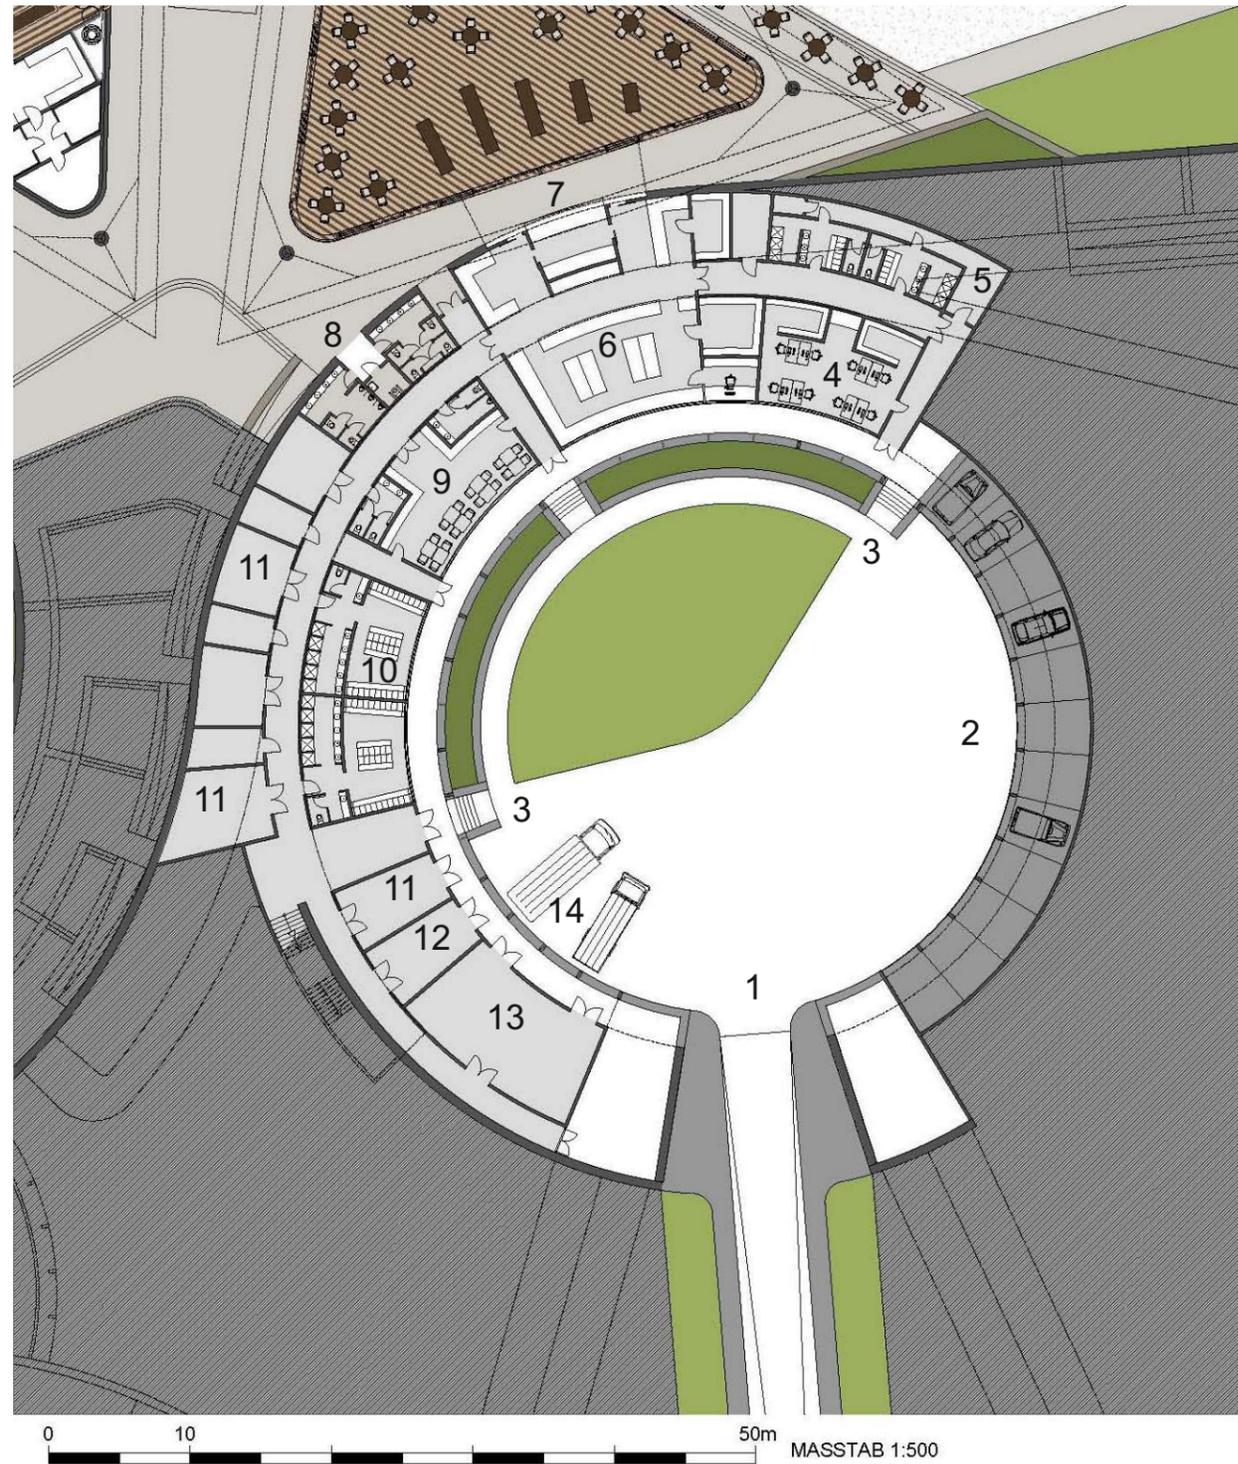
Grundriss Lieferhof und Serviceeinrichtungen
